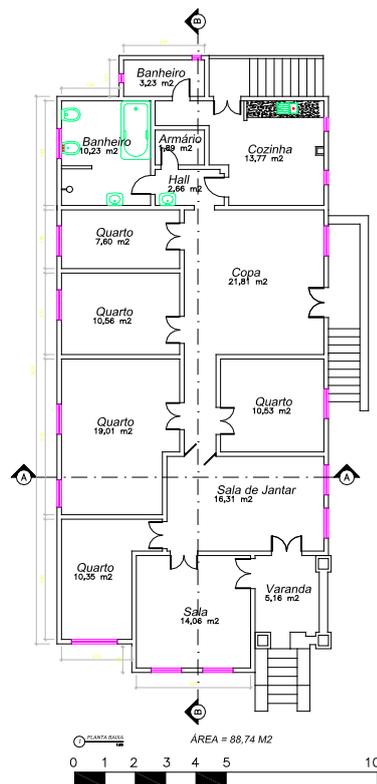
Planta pavimento térreo - Casa Senador Dirceu Cardoso
